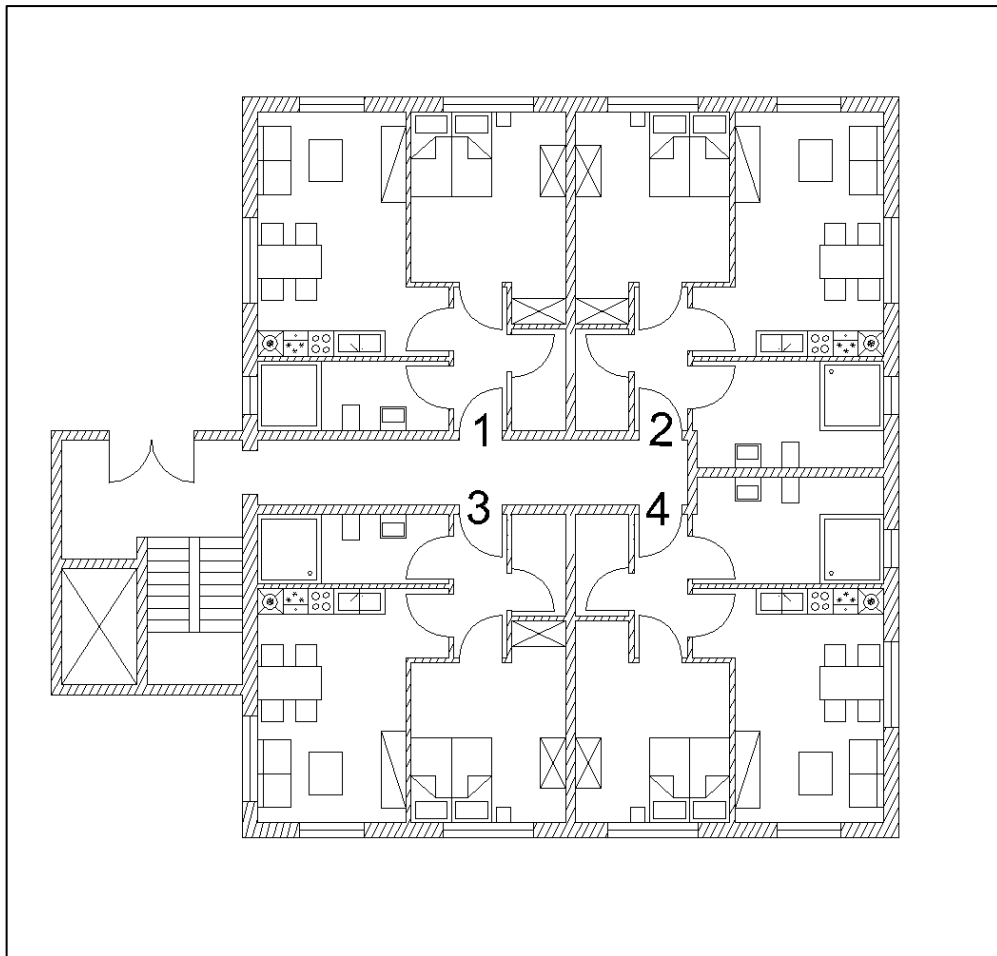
Grundriss eines Regelgeschosses (ohne Maßstab)
